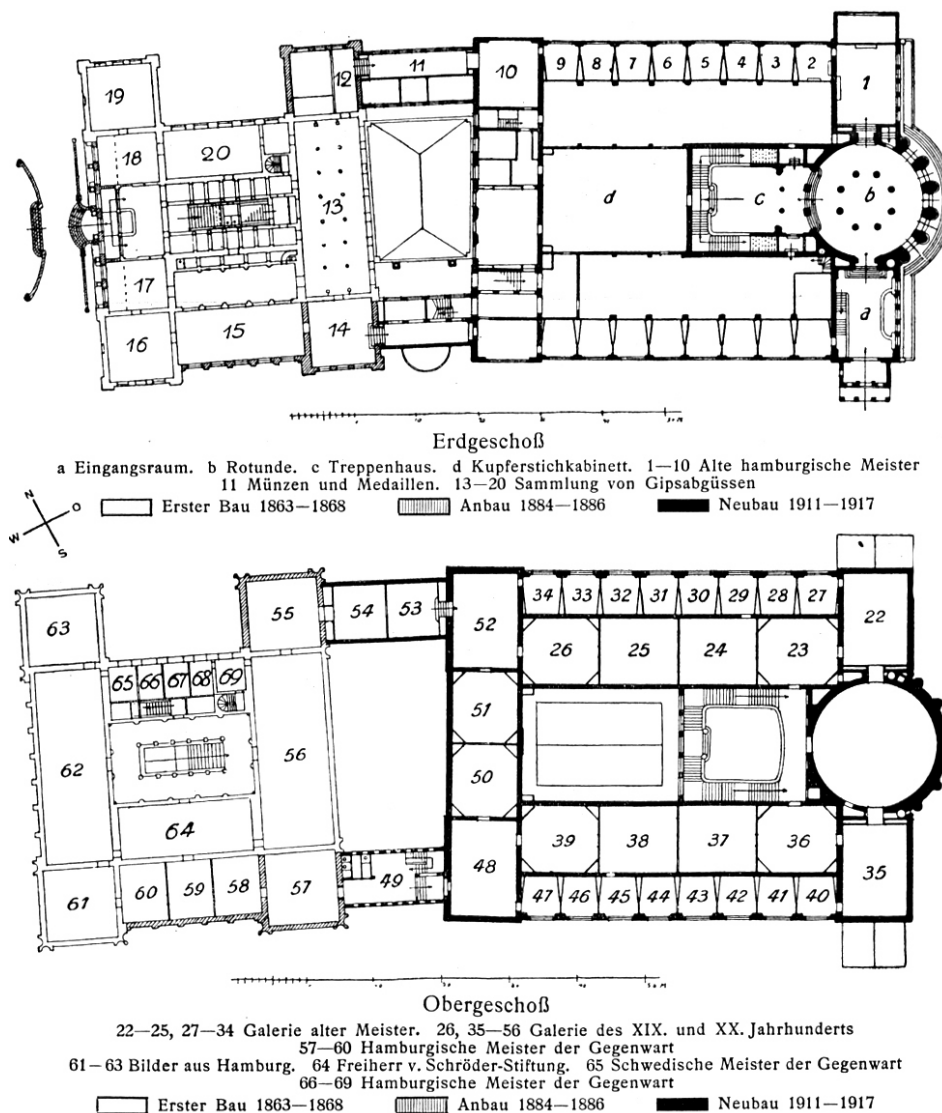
Grundrissplan der Kunsthalle, 1926
